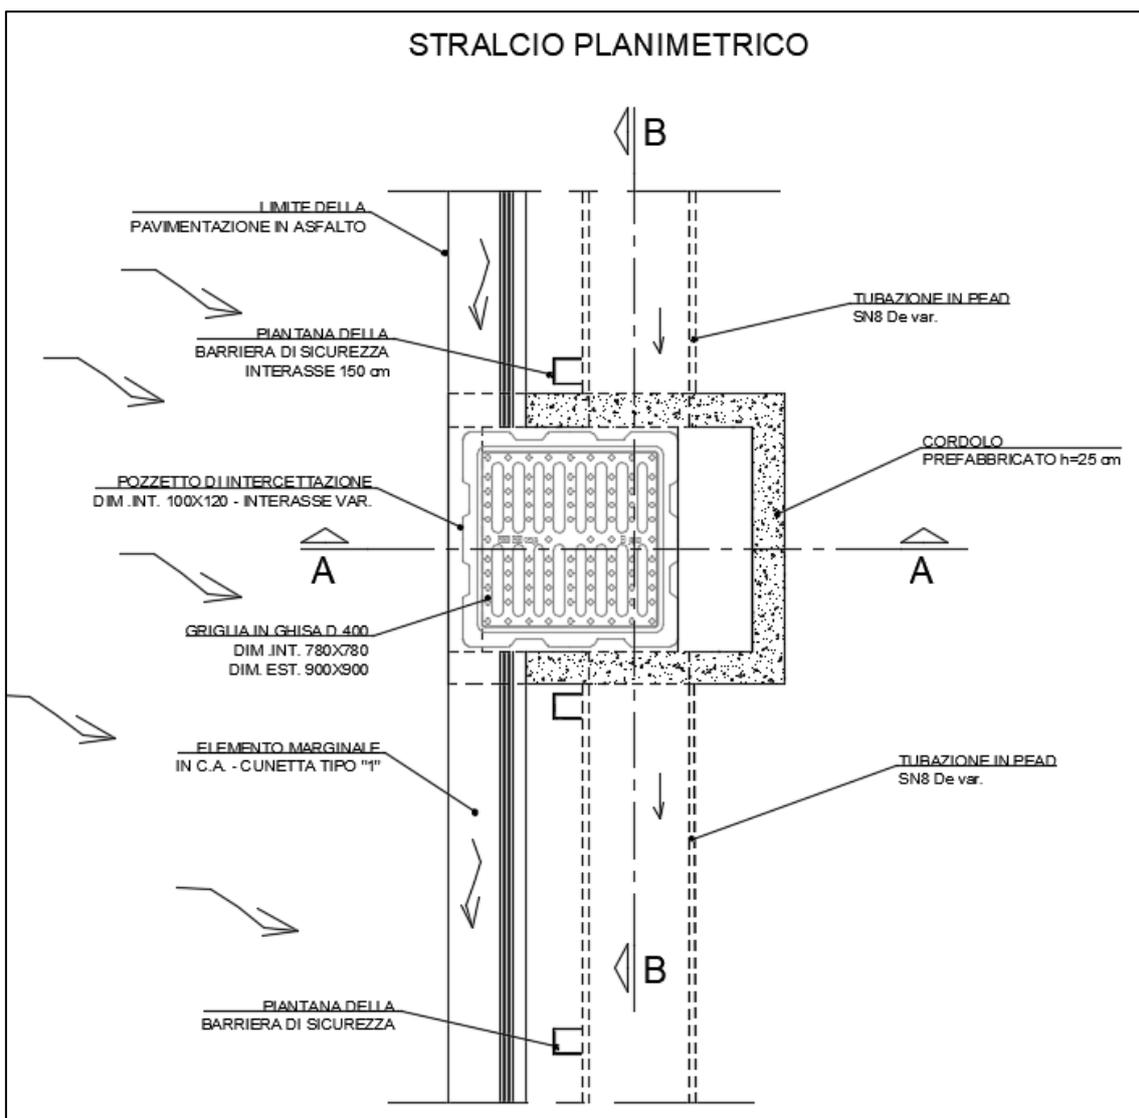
Sistema di scarico in rilevato – stralcio planimetrico
